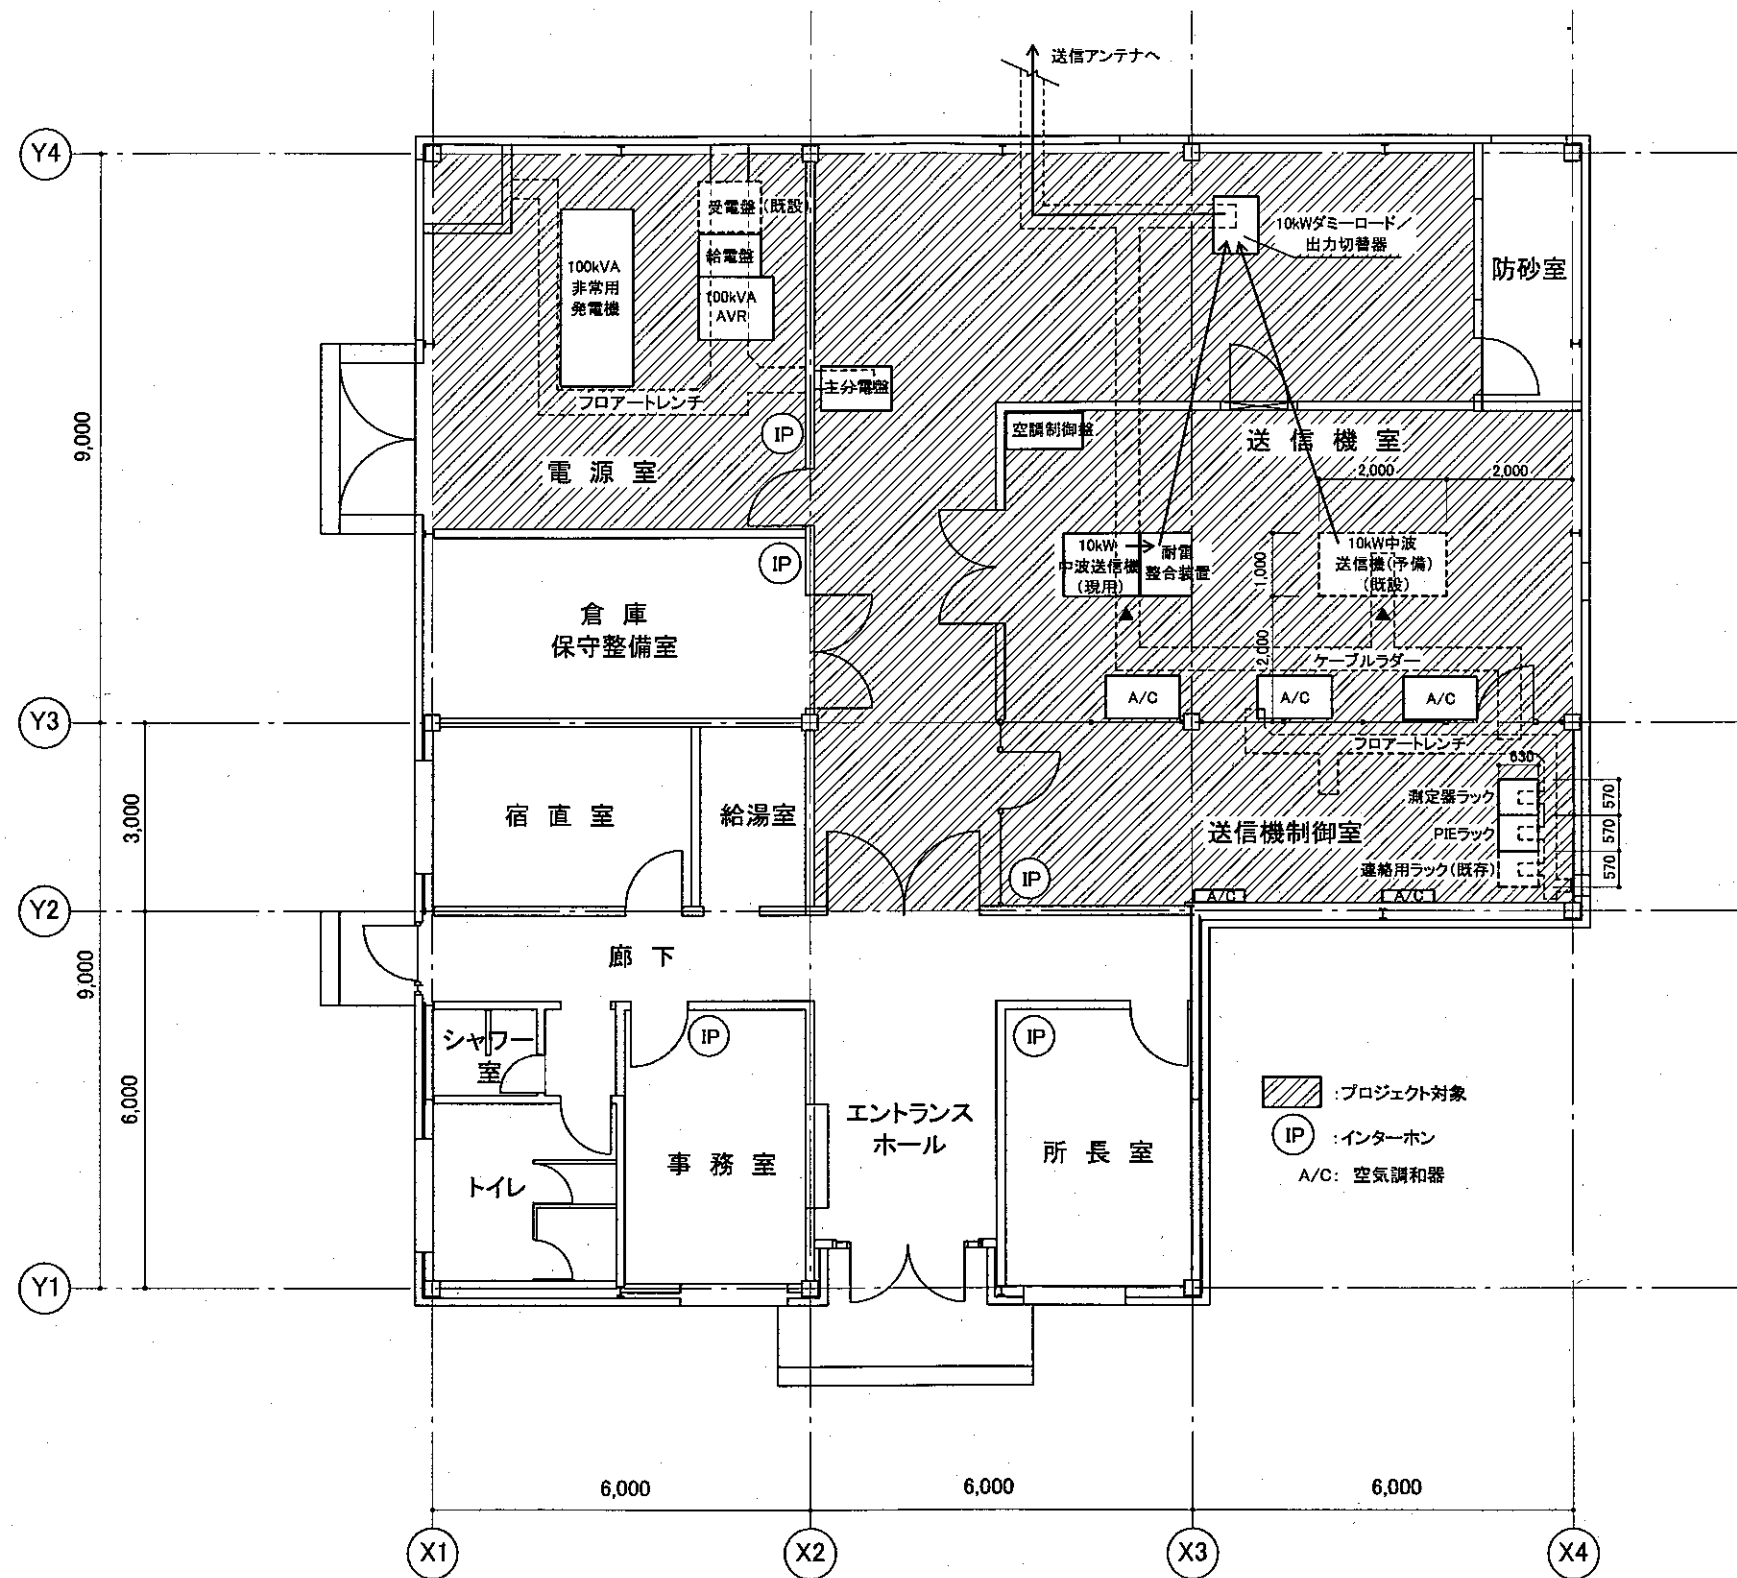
バルディバス 10kW中波送信所 機器配置平面図
